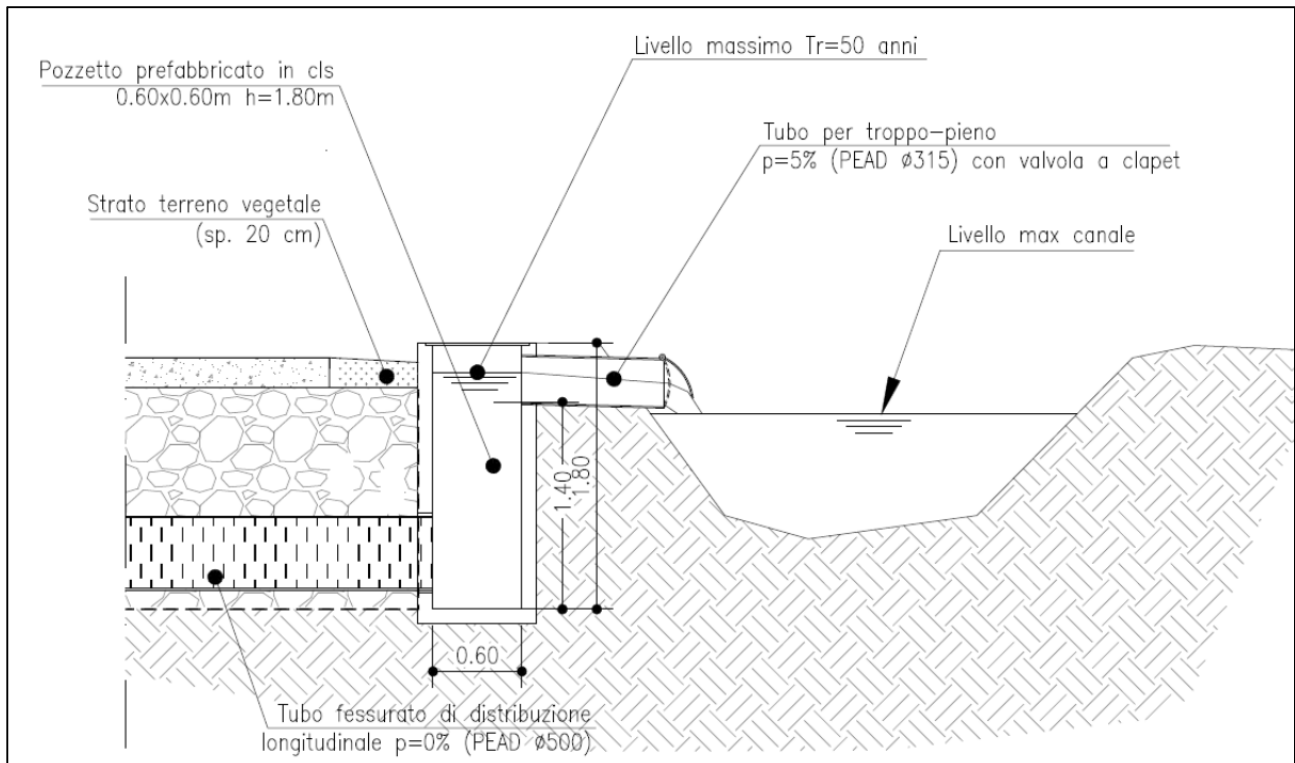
Sezione B-B illustrativa del recapito delle acque dalla canaletta trapezoidale al cassonetto drenante
